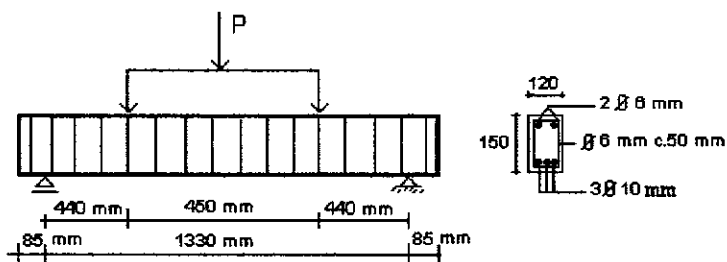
15 – Características das vigas ensaiadas por NGUYEN et al.
